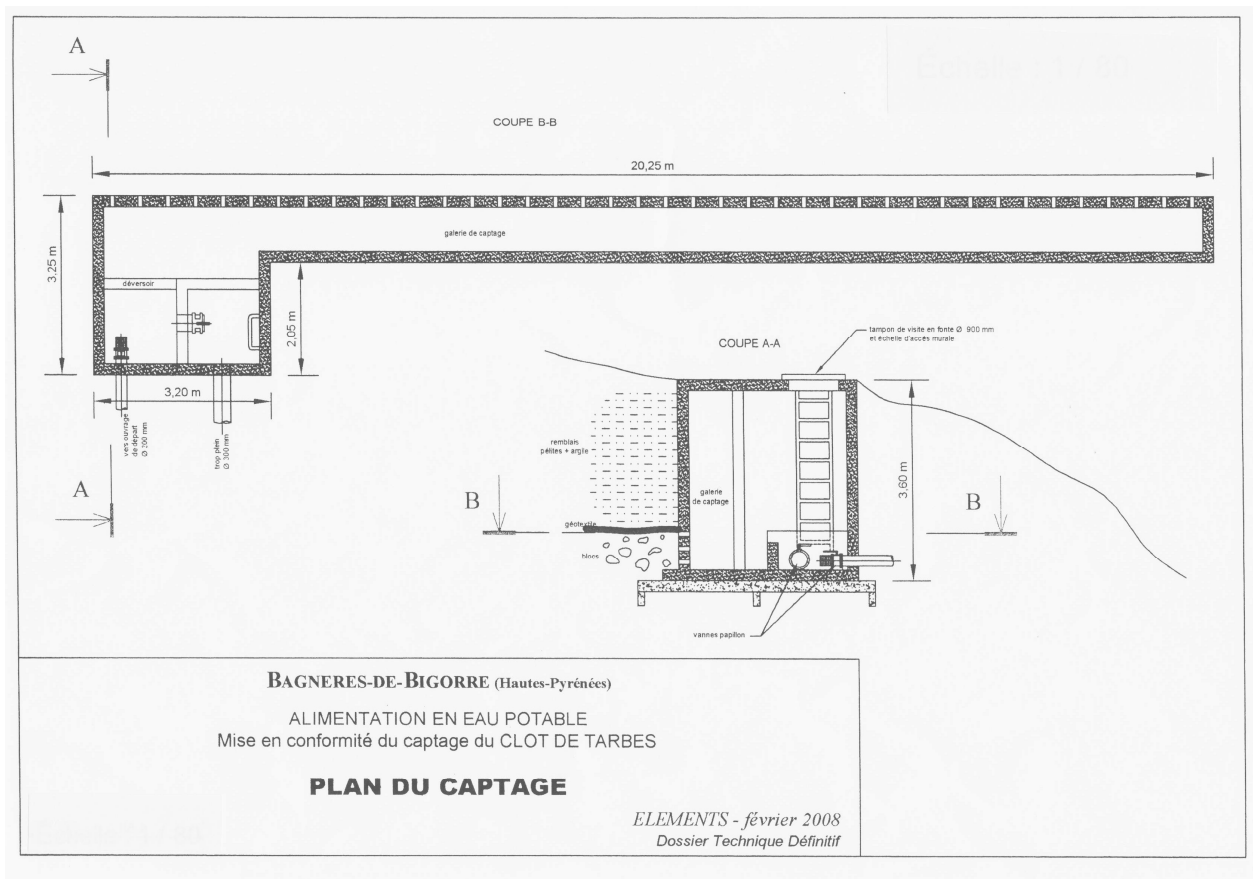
PLAN DE L'OUVRAGE DE CAPTAGE (document Éléments)
